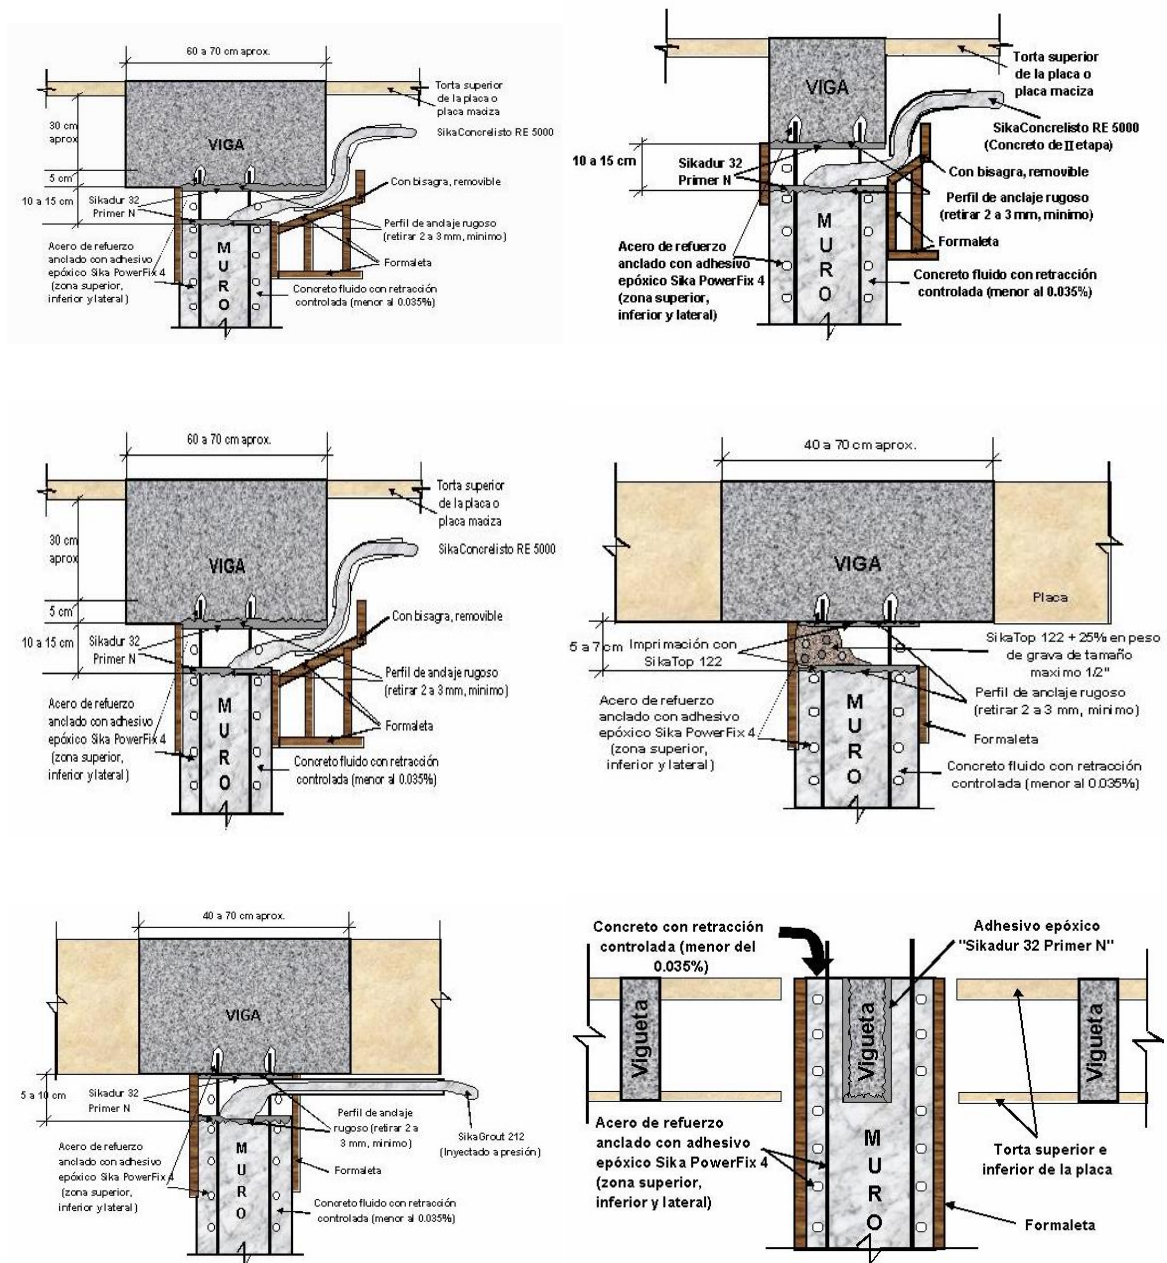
Reforzamiento vigas, columns y muros de contencion
